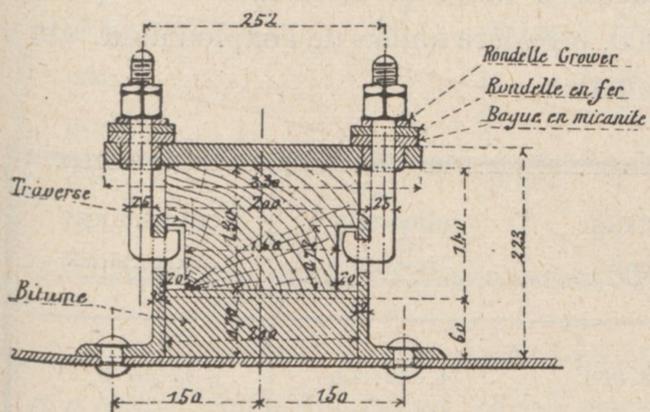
PLAN MONTRANT LA FIXATION DES TRAVERSES SUR LE TABLIER MÉTALLIQUE.
